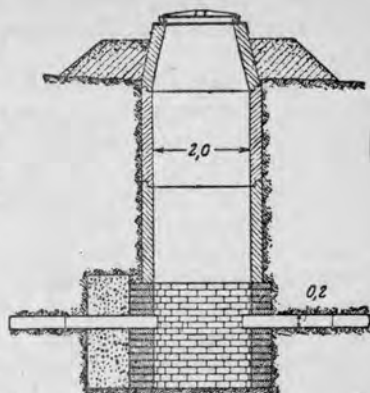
Бетонные шахтные колодцы с водопроницаемой оболочкой из каменной кладки.
